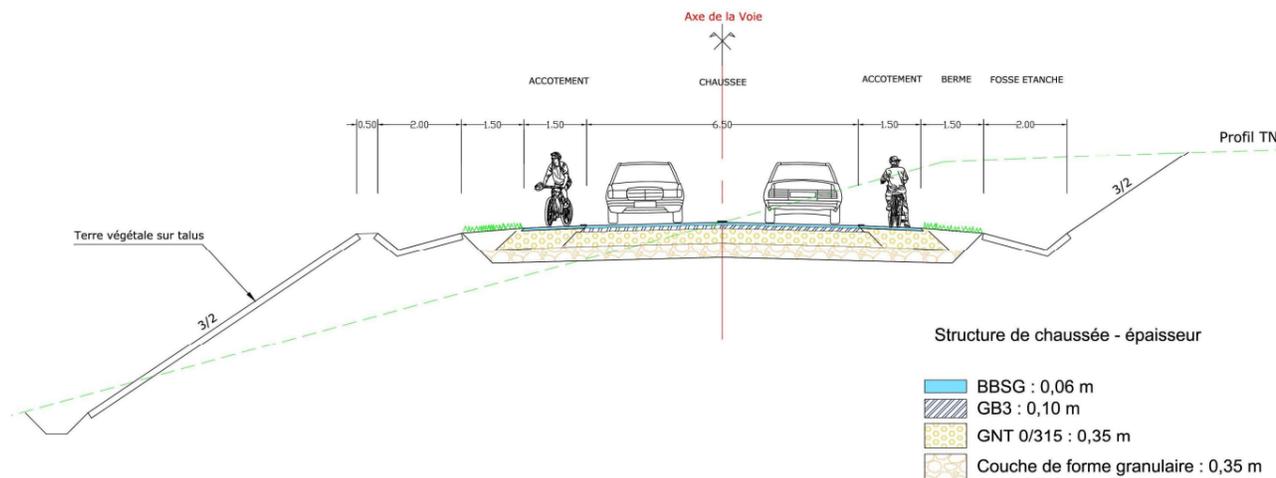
Profil en travers type "Réseau Primaire de Désenclavement"
